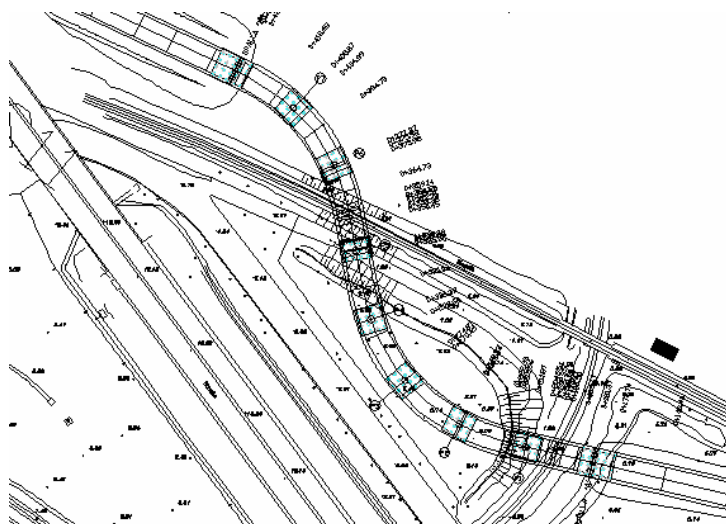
Stralcio Planimetrico del viadotto E
